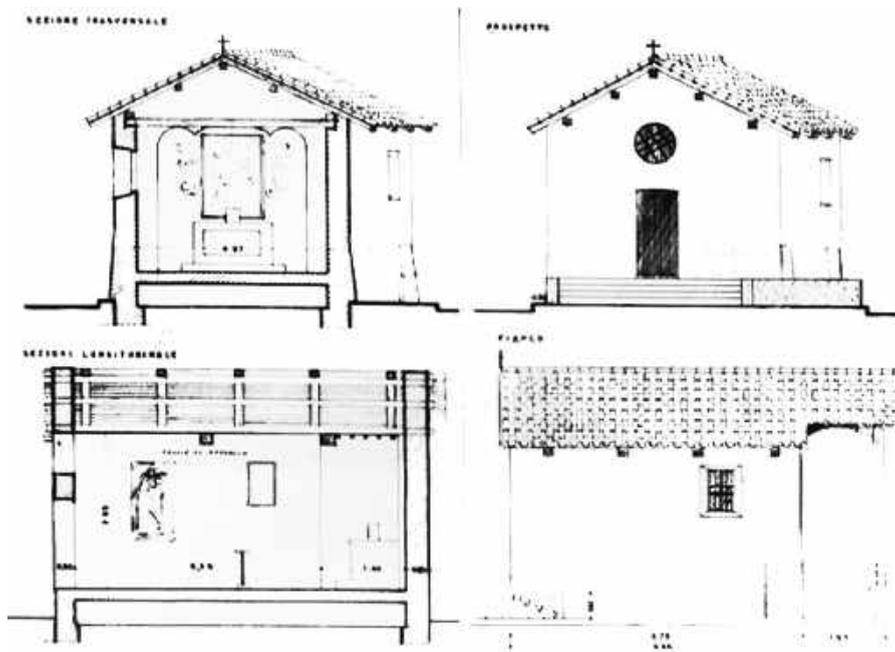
Sezione trasversale, prospetto d'ingresso; sezione longitudinale, prospetto laterale
